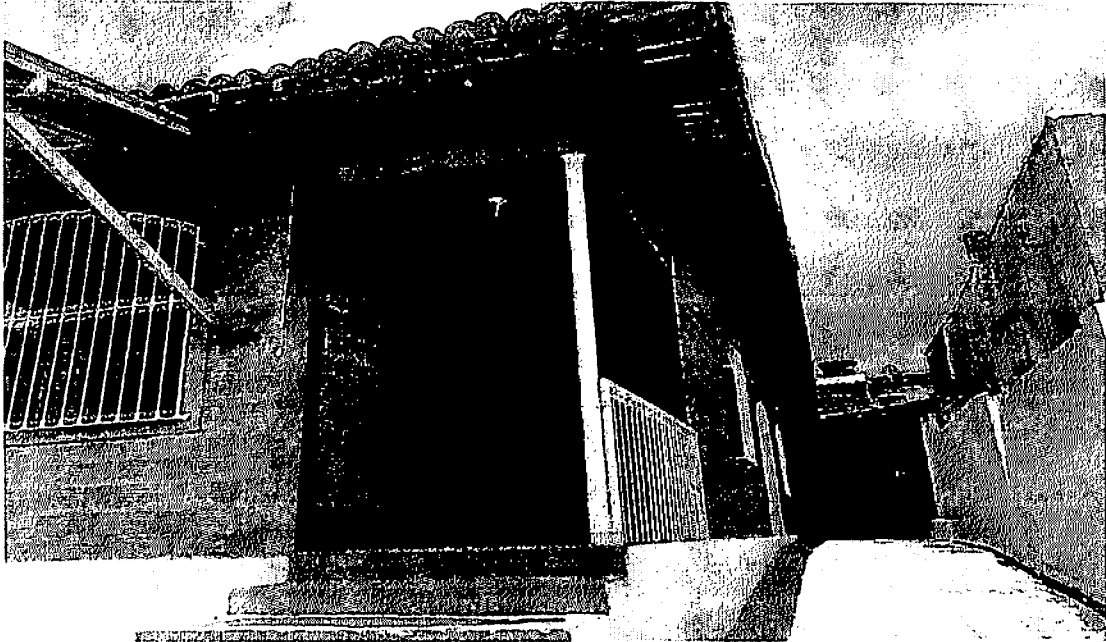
Acesso a área interna cobertura em madeiramento e telha cerâmica.
